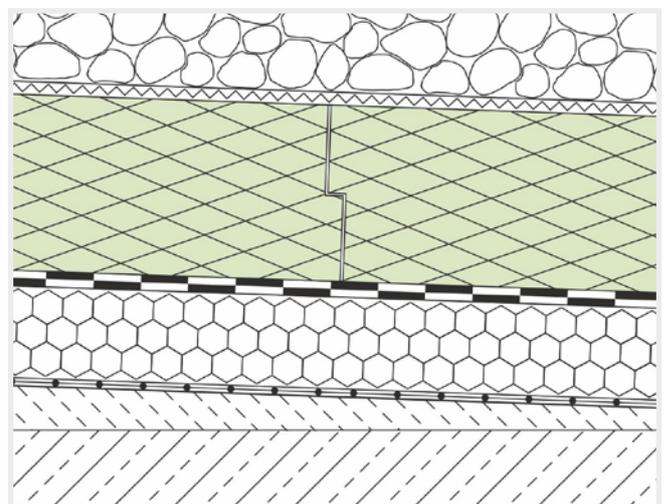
Saniertes Plusdach mit Gefälledämmung im Altbestand.
